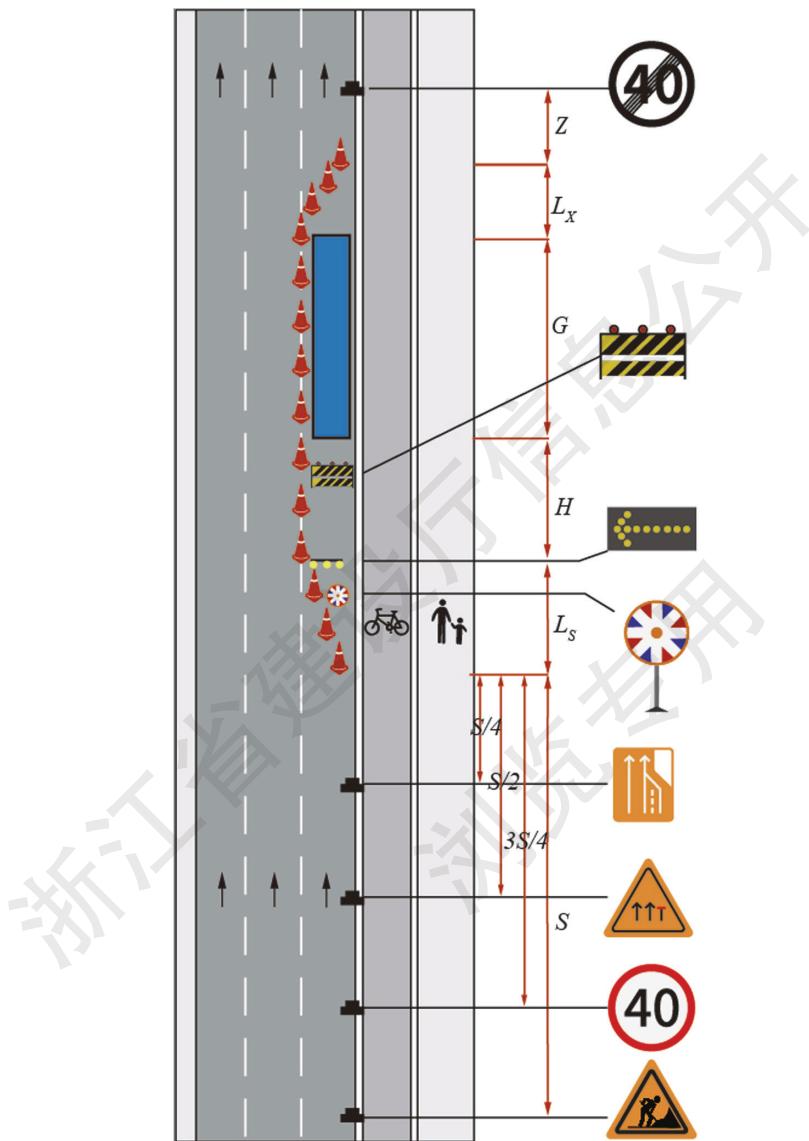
主干道远离交叉口养护作业控制区布置示意
